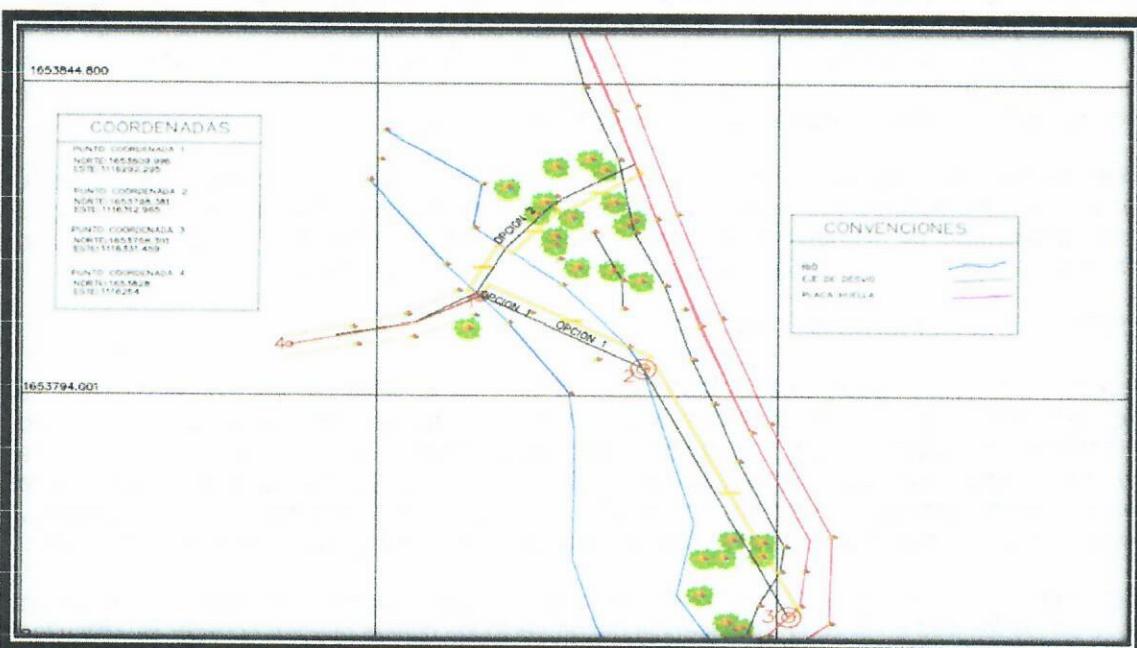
Vista en planta del área a intervenir sobre el río a Marquezote
